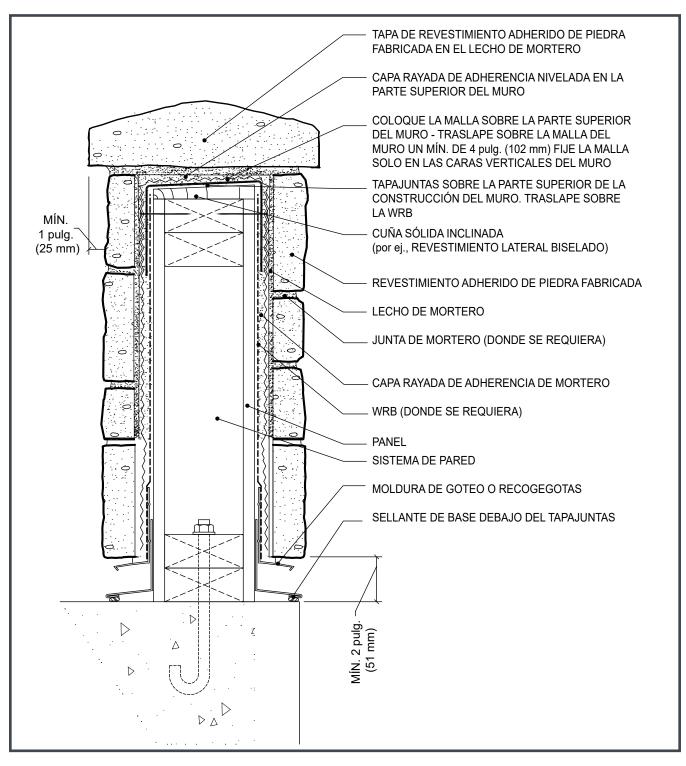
Muro con sistema de impermeabilización - Sistema de membrana
